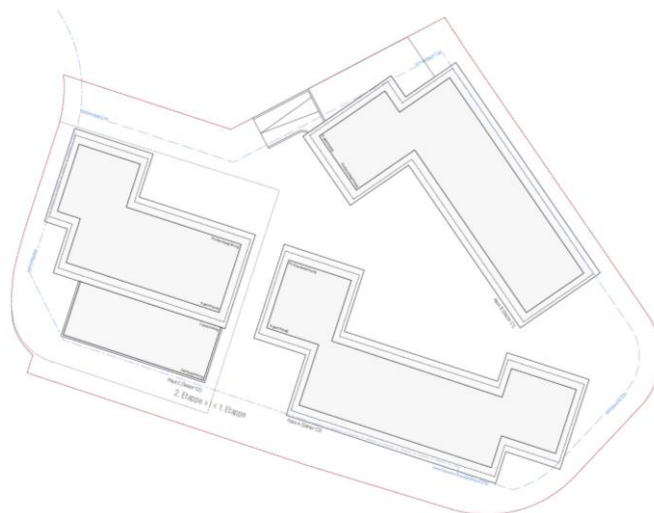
Planausschnitt Dachaufsicht – Flächen für Dachbegrünung und PV-Anlagen (grau)
